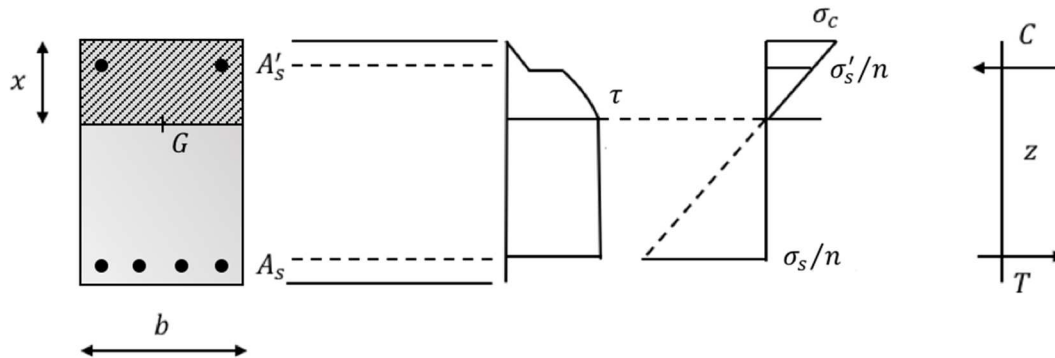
Tensioni in STATO II – Sezione fessurata
